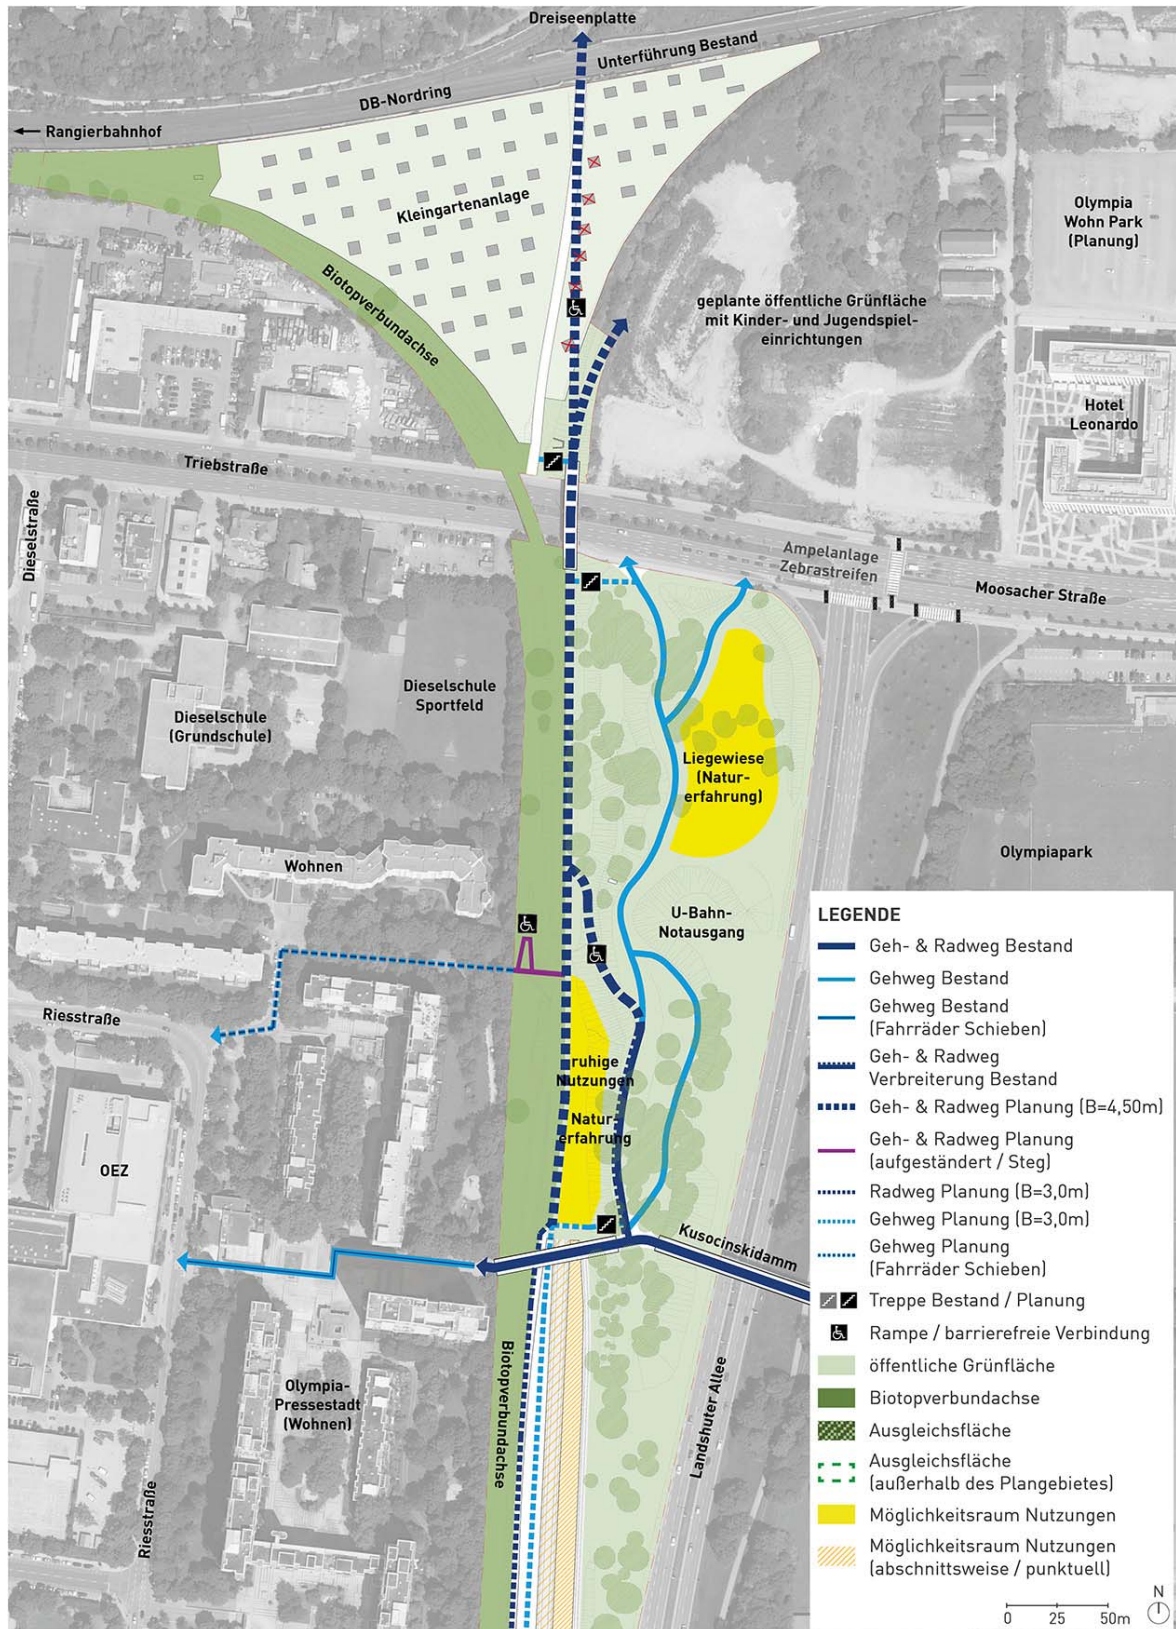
Teilbereich Nord (Verkleinerung, Originalmaßstab Lageplan 1:1000)
